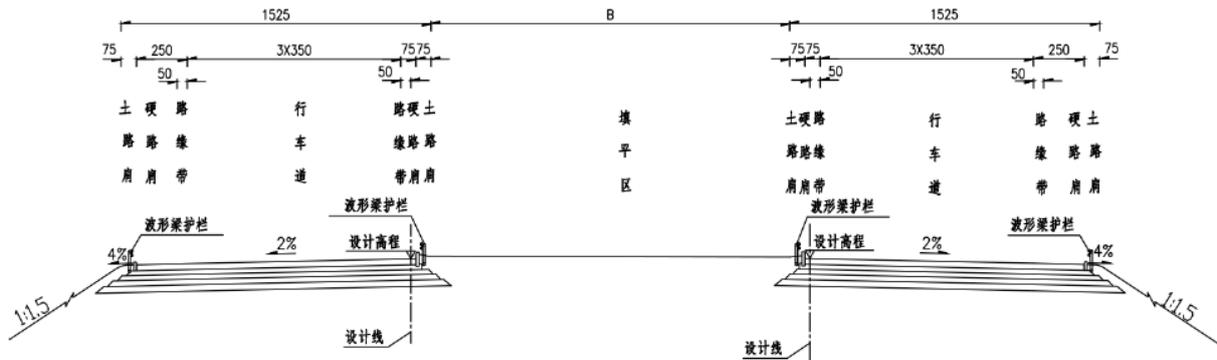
YK0+920~YK1+125 段分离式路基横断面图
